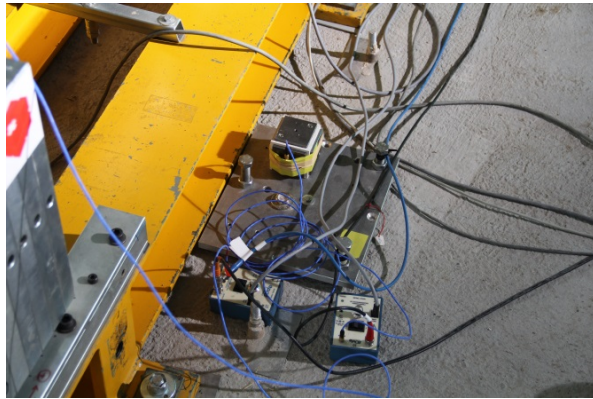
Messstelle P13: Messung der Beschleunigung der HBV-Decke direkt neben dem Schwingungserreger mit einem auf dem Holzwürfel der Sensorplatte montierten Beschleunigungssensor PCB 3701G3FA3G.
